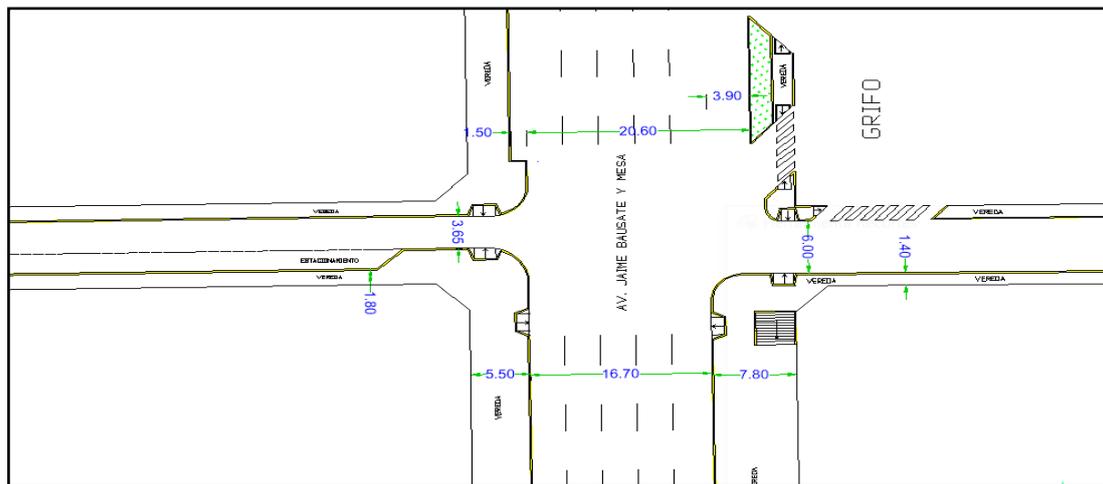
Vista en planta de situación actual en el cruce de la Av. Renovación y Bauzate y Meza.
